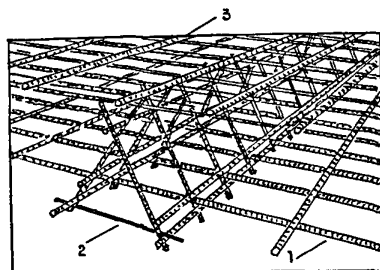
Армирование плиты по схеме — нижняя арматурная сетка —
